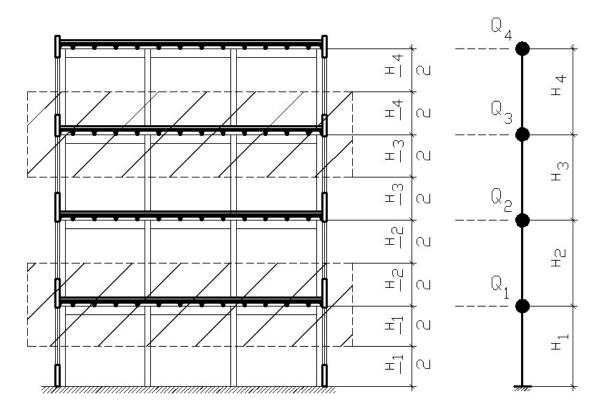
Формирование динамической расчетной схемы каркаса многоэтажного здания а) поперечный разрез здания; б) динамическая расчетная схема.
